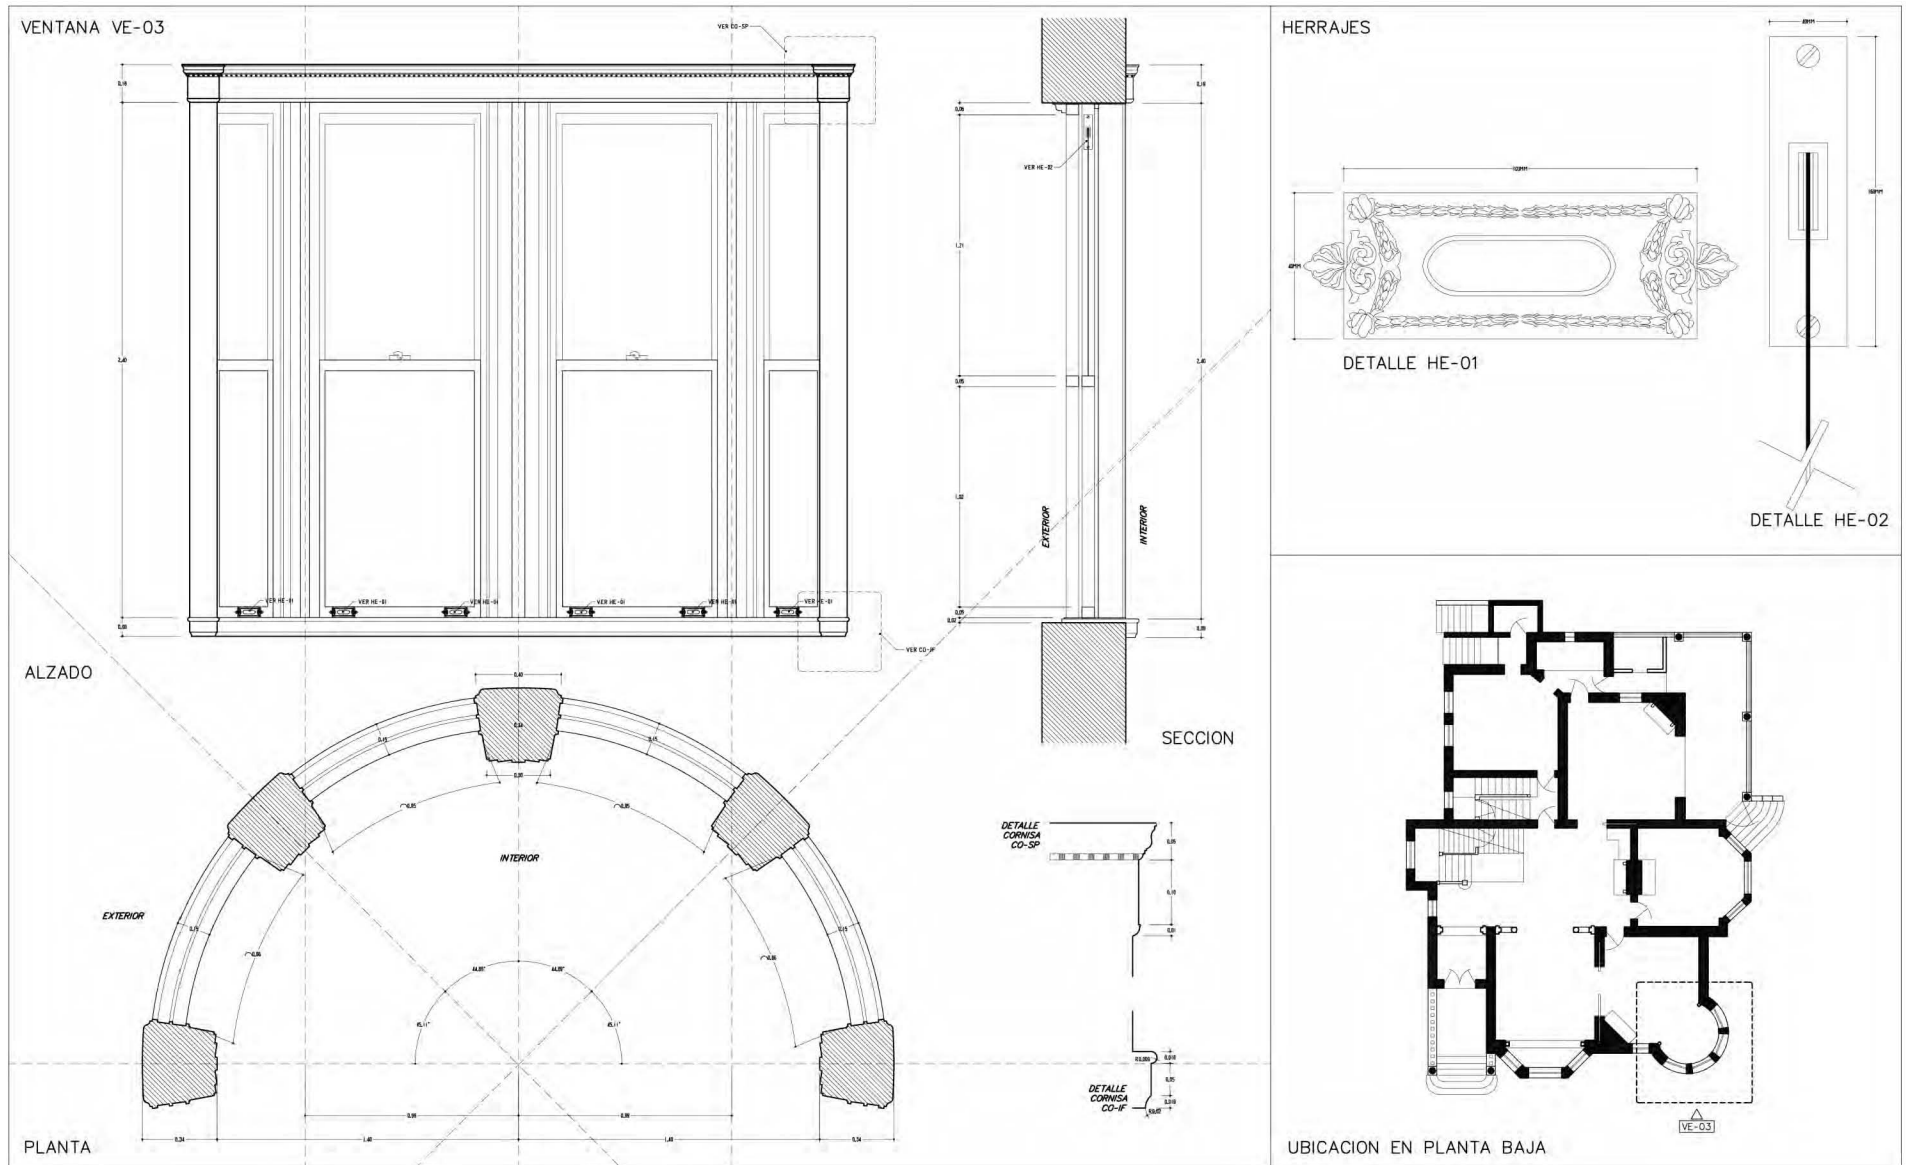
Plano de carpinterías 02 de General Gómez Pedraza 72. Elaboración propia. Fuente: Levantamiento en sitio. Fecha: noviembre 2017.
